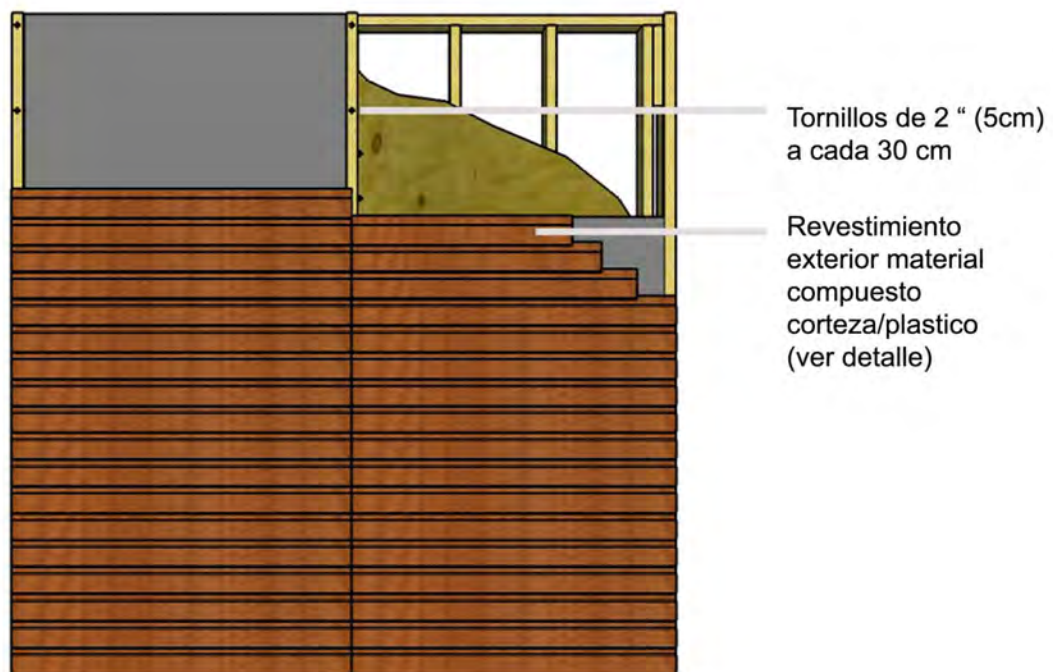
Especificaciones de colocación de contrachapado en panel. Fotografía propia, 2014.
